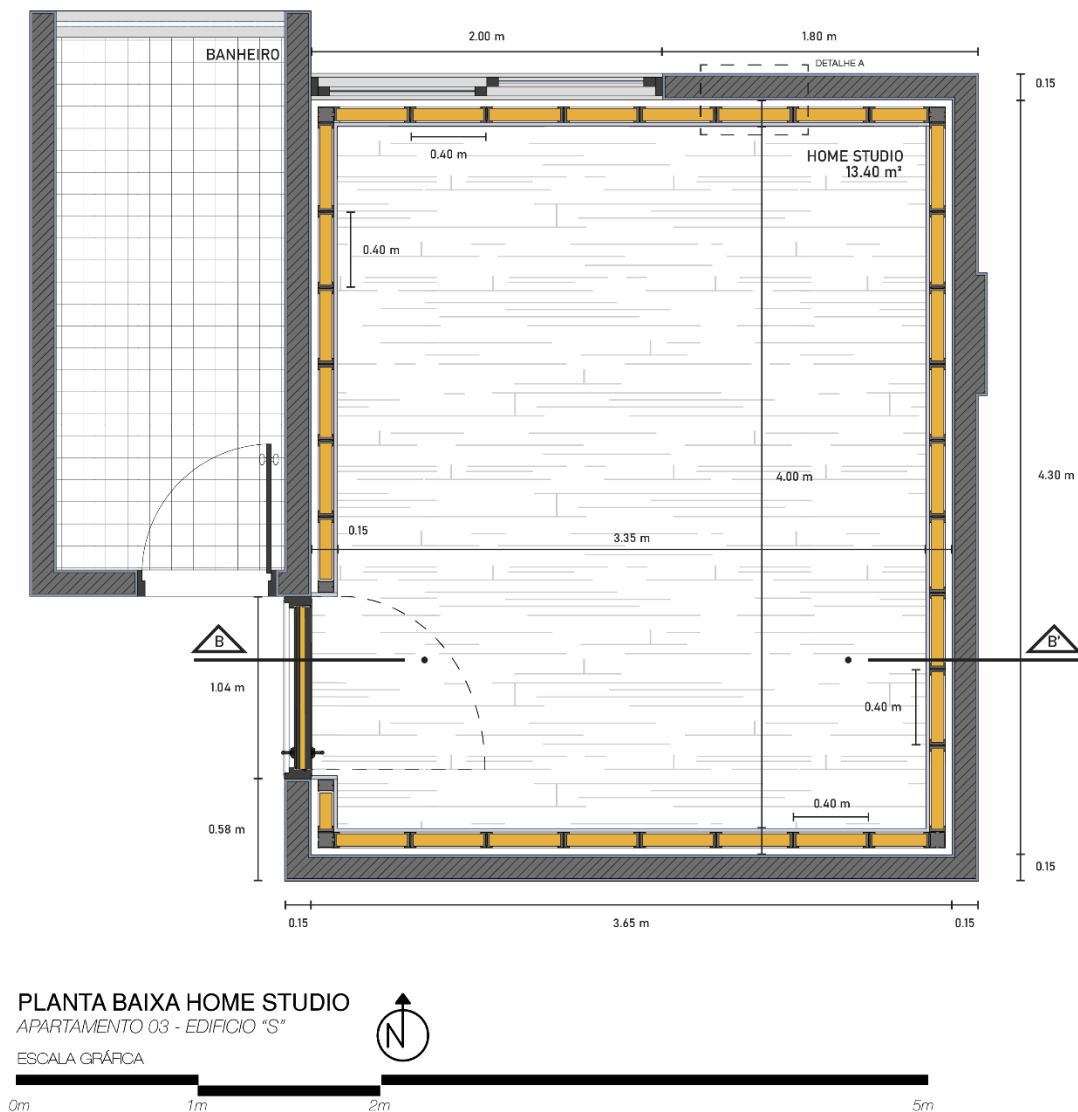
Planta baixa. Proposta para o Isolamento Acústico (Reajuste das dimensões)
